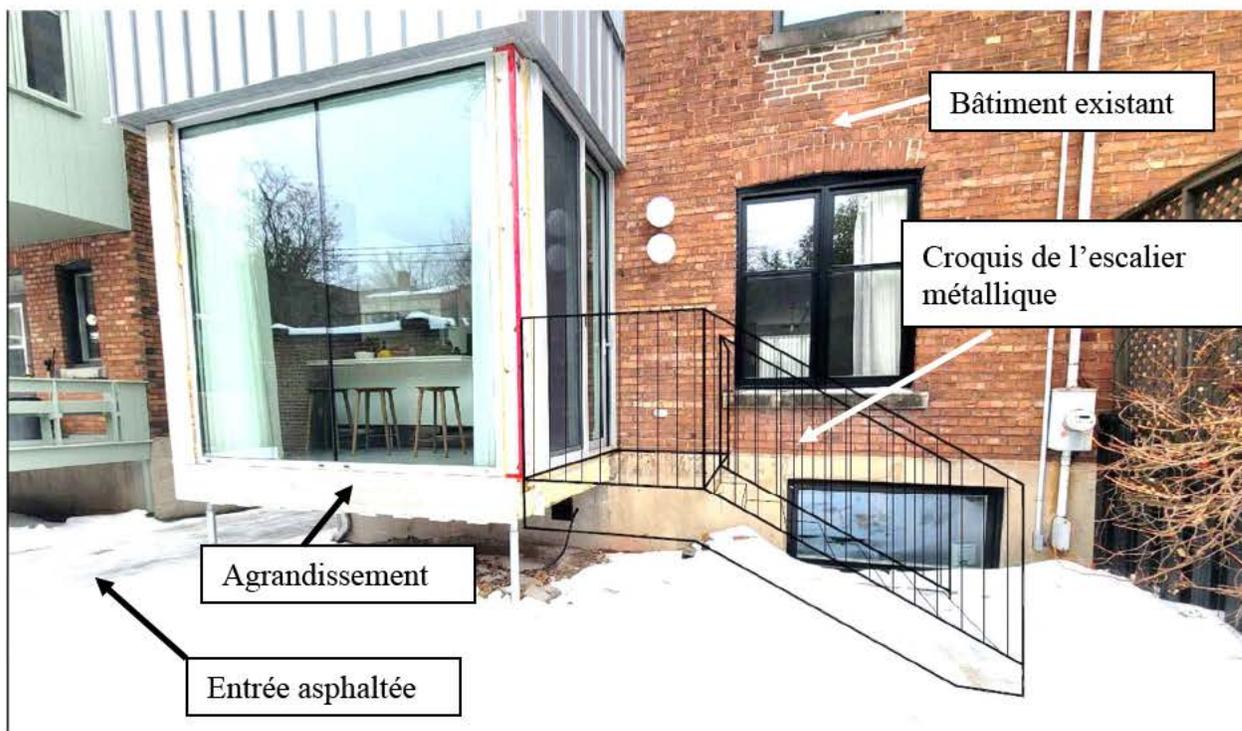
Arrière du bâtiment et croquis de l'escalier
